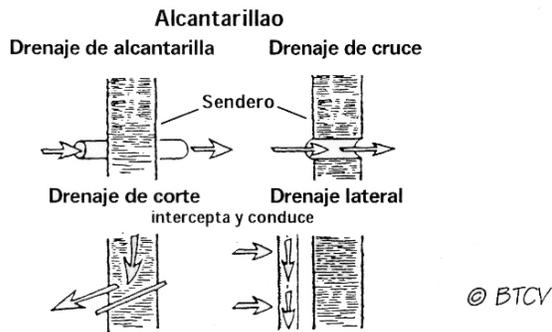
TIPOS DE SISTEMAS DE DRENAJE
